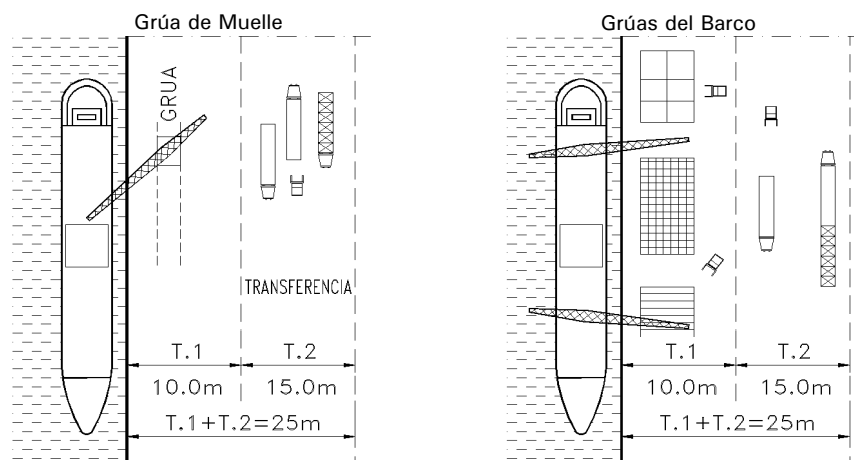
Ancho de Cubierta del Muelle (T.1 y T.2)
